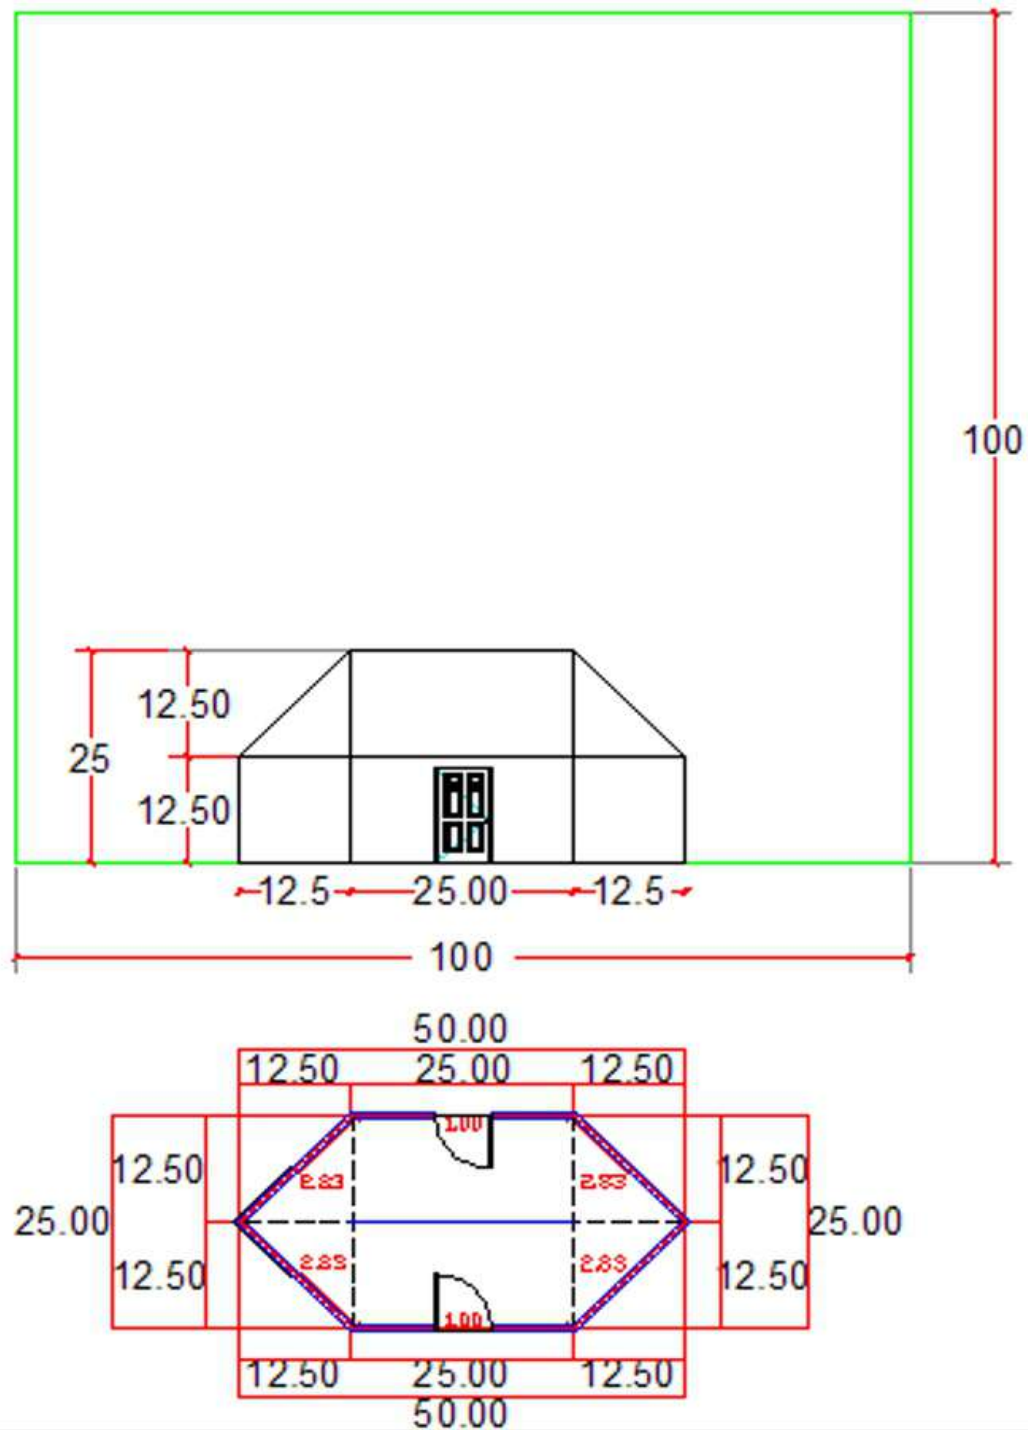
Dimensiones en centímetros de: Secciones transversales del modelo de CM2 escalado a 1:16 en cámara de ensayos y planta del modelo de CM2.
